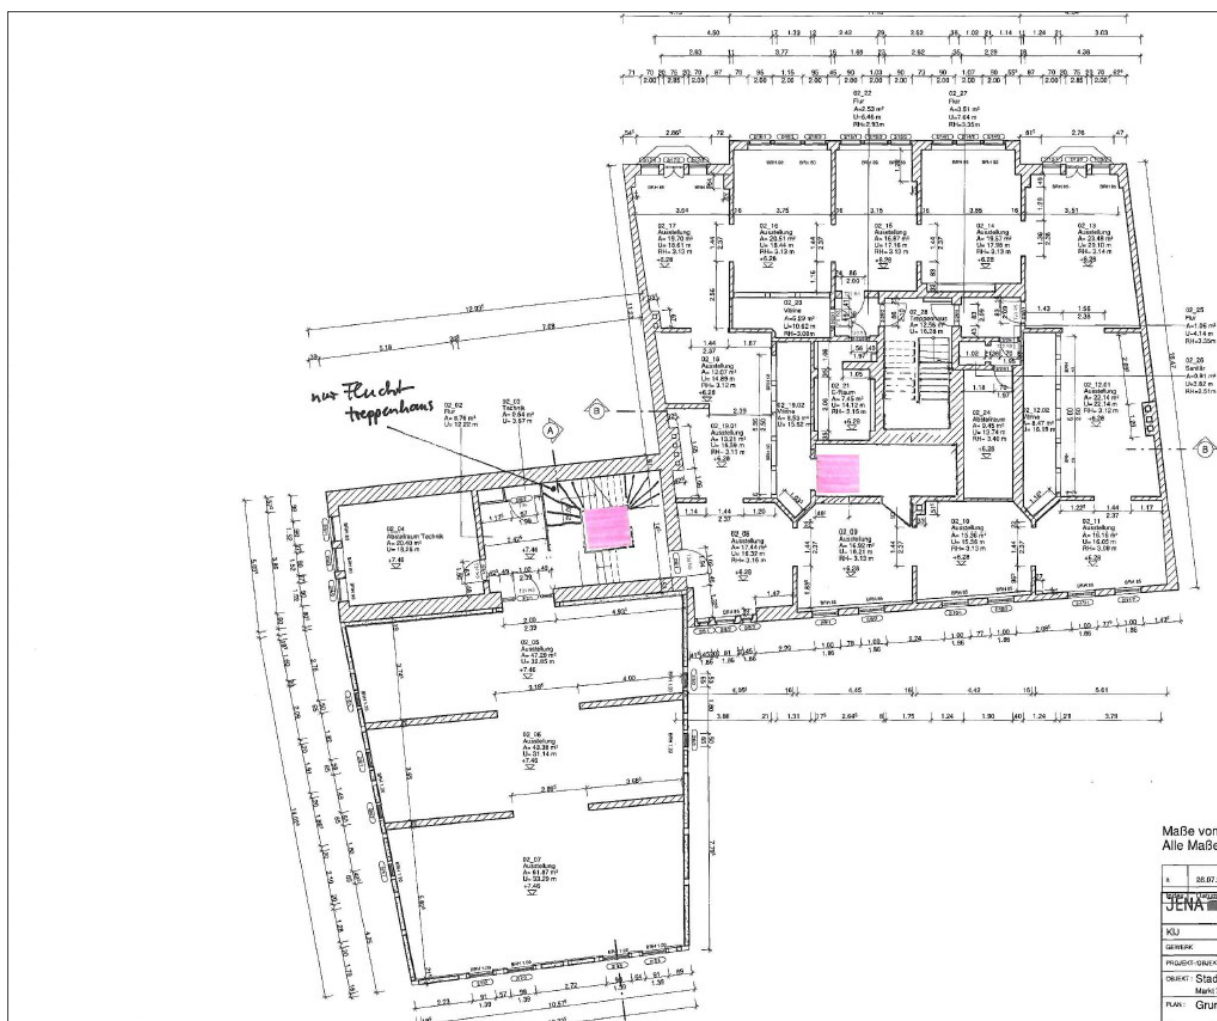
Grundriss Erdgeschoss, Positionierung Aufzug und Eingang zum Gebäude, Variante Treppenhaus Neue Göhre; Verfasser Wolfgang Winkler, Kommunale Immobilien Jena
